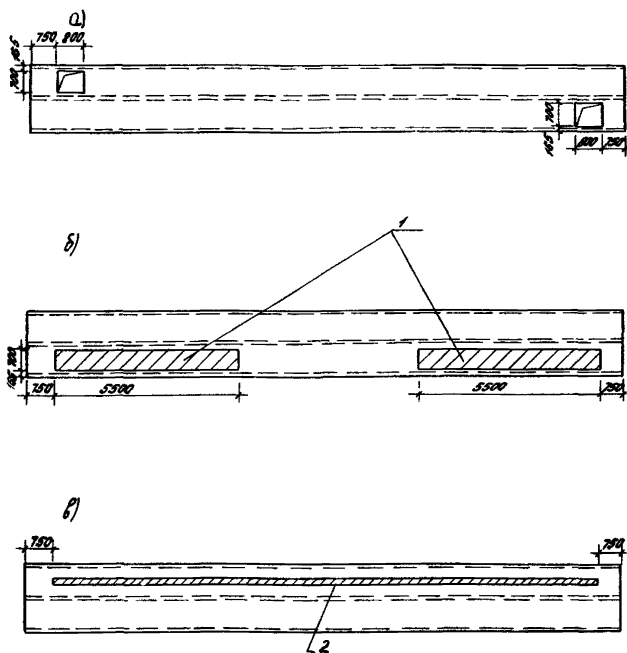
Схема возможного размещения отверстий в нижней полке коробчатого настила
